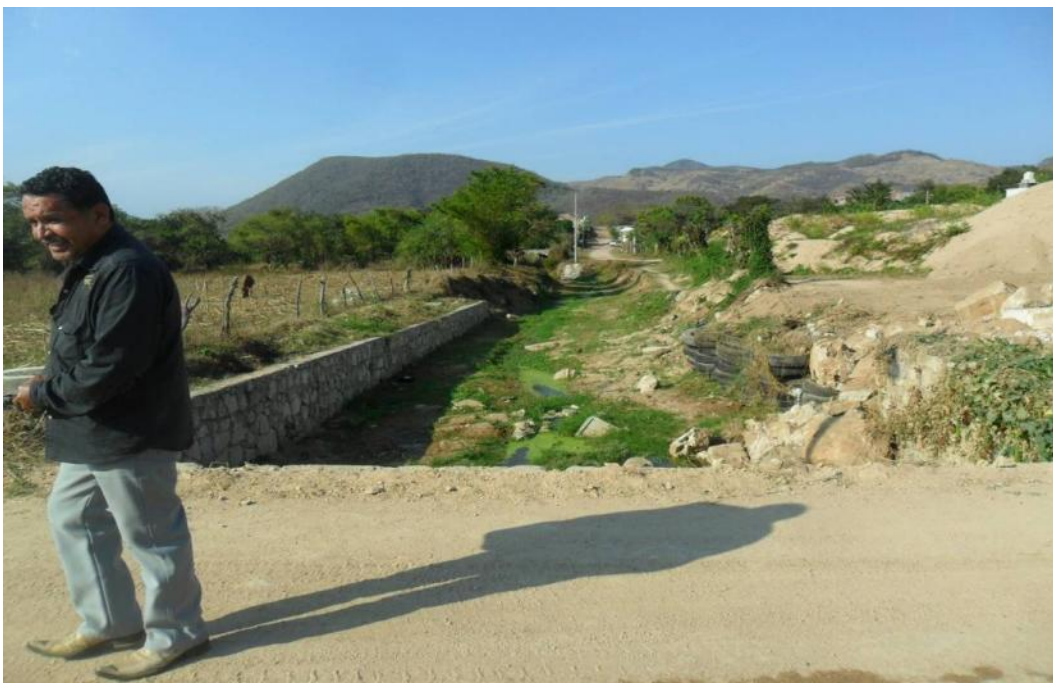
Localidad: Cintalapa. Pasó del dren por una de las últimas calles de la ciudad, observando que este puente se encuentra dañado.
